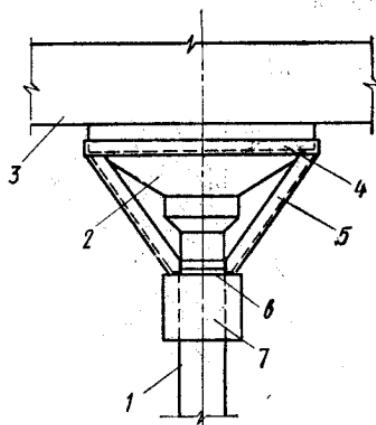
Усиление капителей безбалочного перекрытия:
